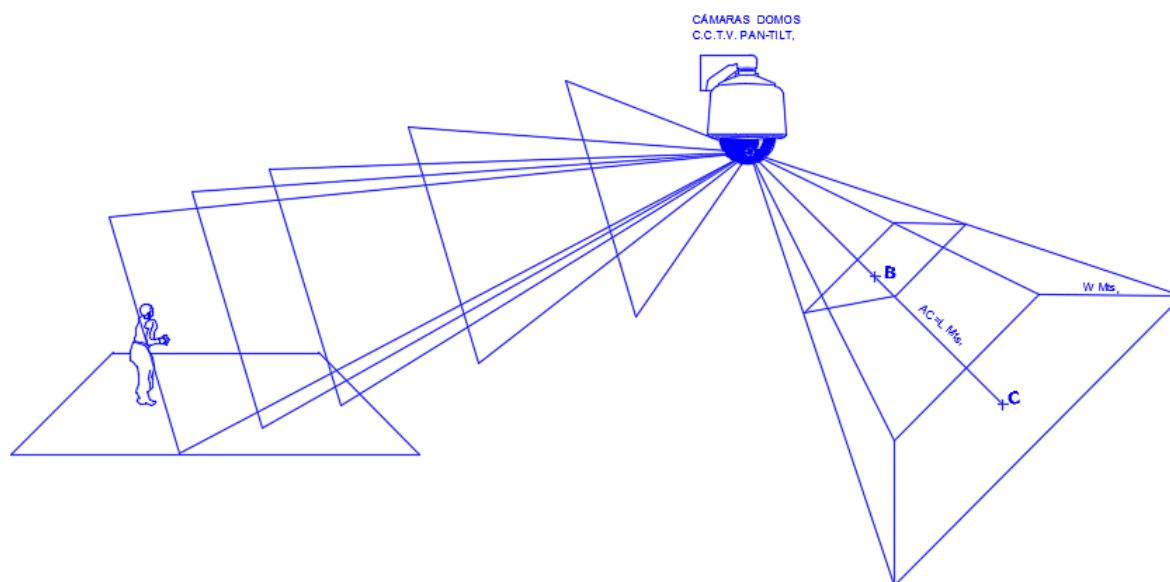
Campos de imagen de cámara móvil con lente zoom
